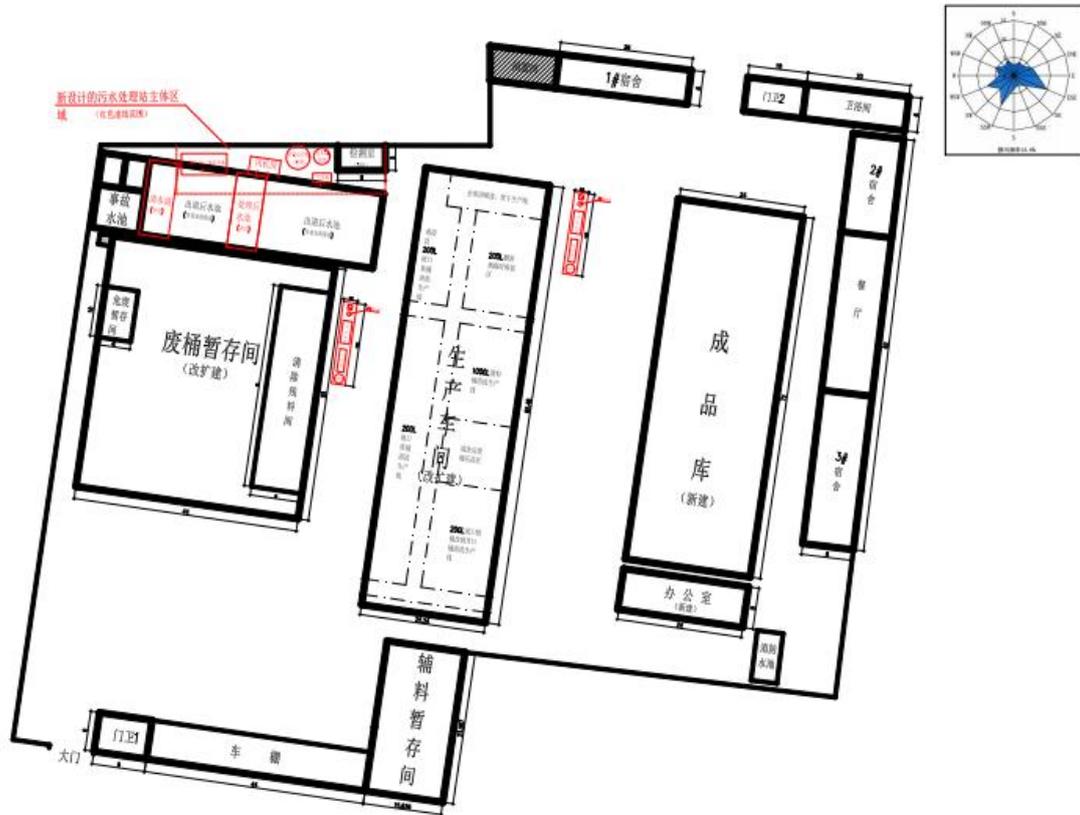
山东玖屹环保科技有限公司平面布置图
